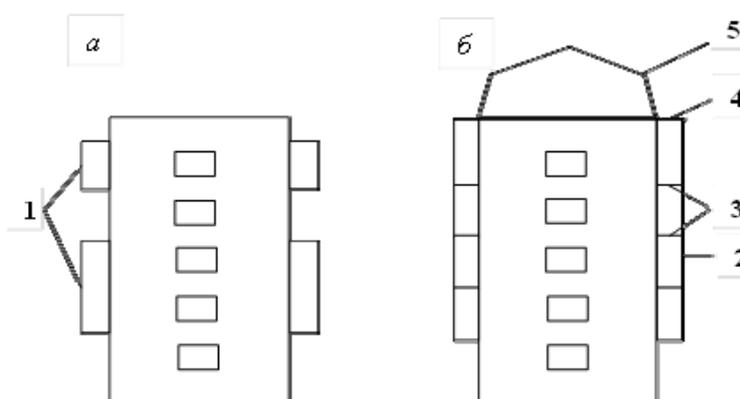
Схемы объединения квартир при помощи примыкающих (а) и подвесных (б) наружных блоков: 1 — блоки по типу «ласточкиного гнезда»; 2 — металлические тяжи; 3 — ригели, закрепляемые в уровне перекрытий к металлическим тяжам и поперечным несущим стенам; 4 — двухконсольная балка; 5 — надстроенный мансардный этаж
